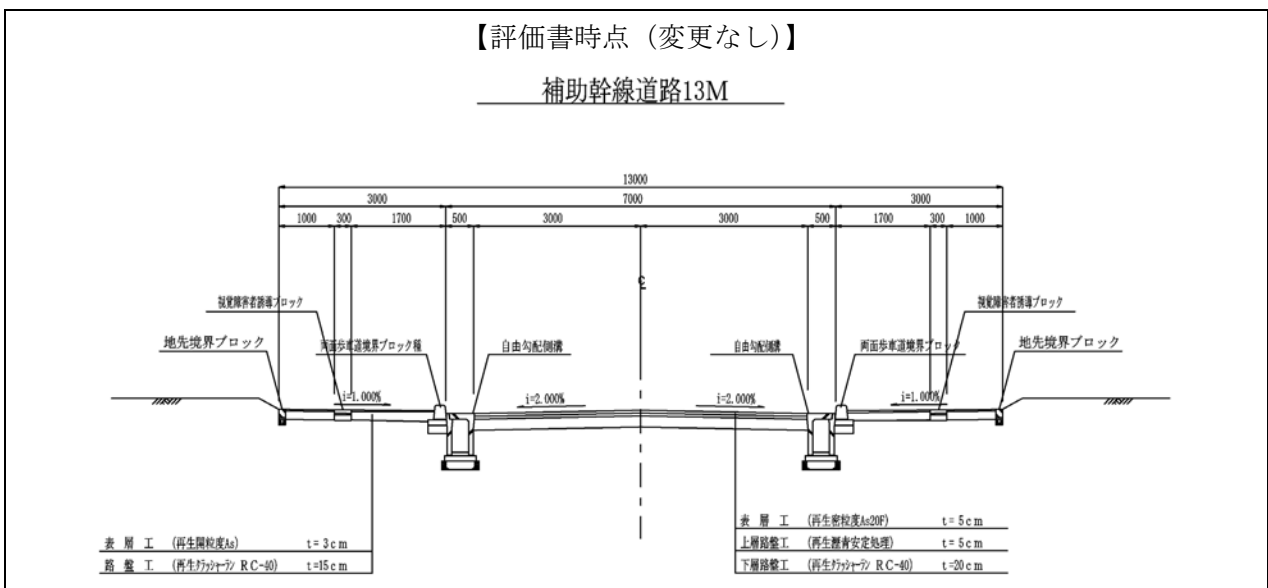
(3) 道路断面図(補助幹線道路:13m 標準断面)
